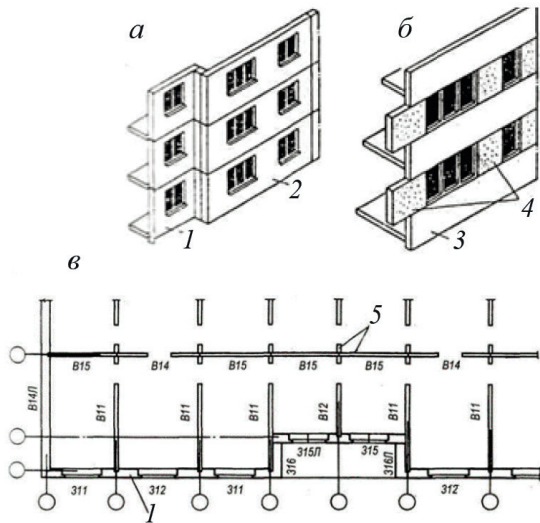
Розрізка стін великопанельних будівель:
